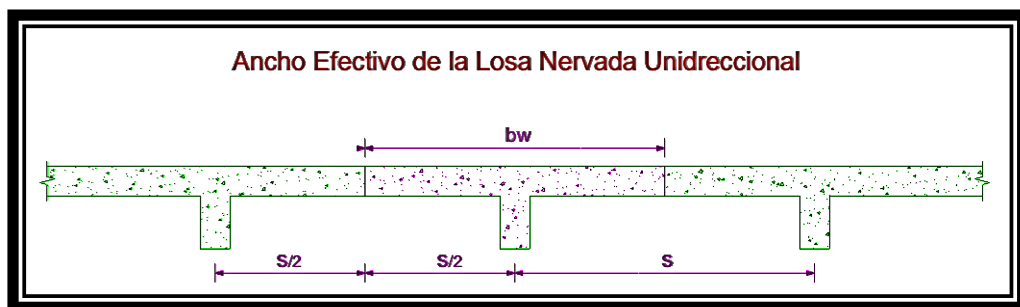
Ancho Efectivo de la Losa Nervada Unidireccional
